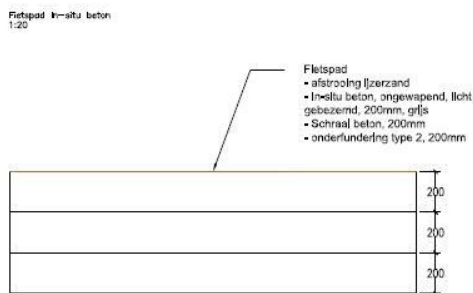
Detail uitvoeringstekening Houtkaai met aanduiding van de omgevingswerken (bron: Stad Aalst)
